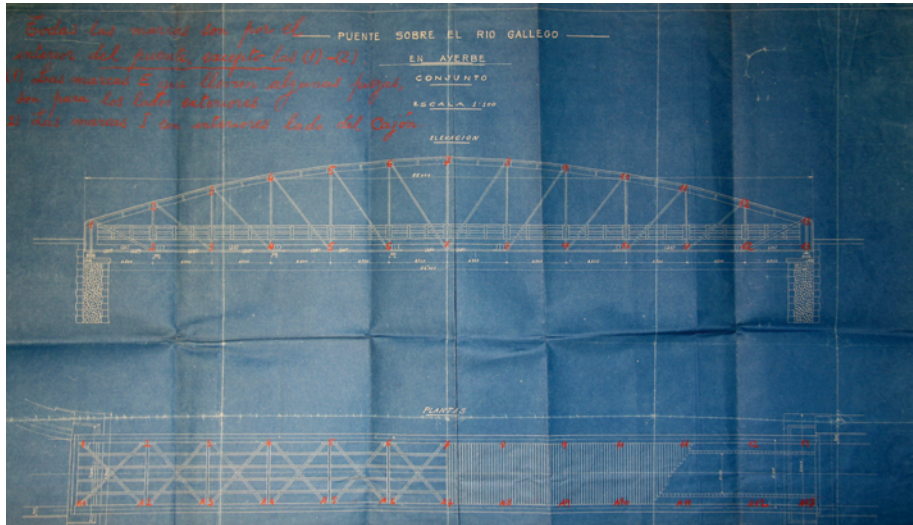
Plano del puente de Hierro sobre el Gállego en la actual A-1202.
